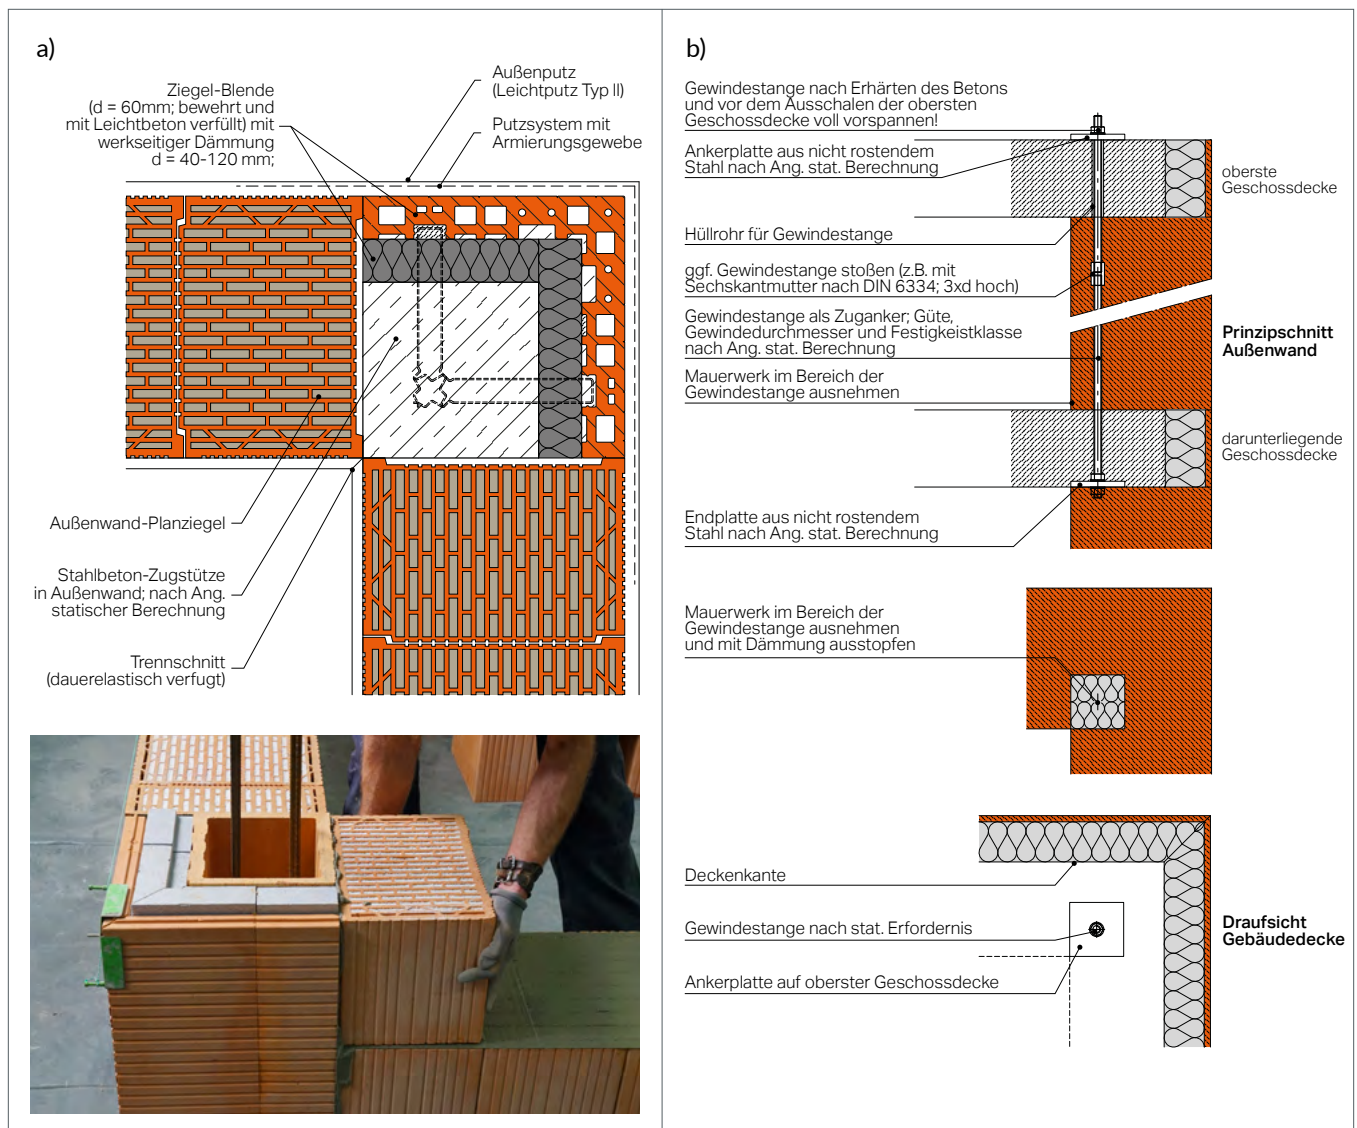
Rückverankerung von Decken mit geringen Auflasten: (a) Zuggpfosten (b) Schlitzung mit Stabstahleinlage
